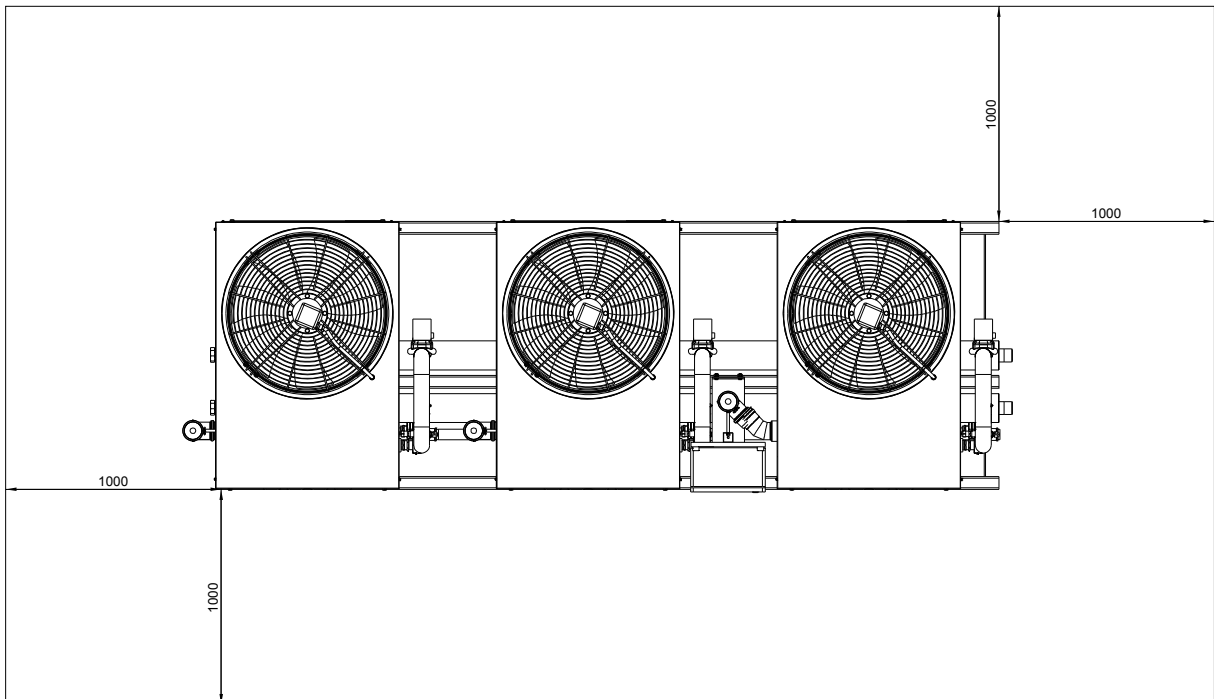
Distanze minime di rispetto (quote espresse in mm) per unità preassemblate in configurazione multi-link
